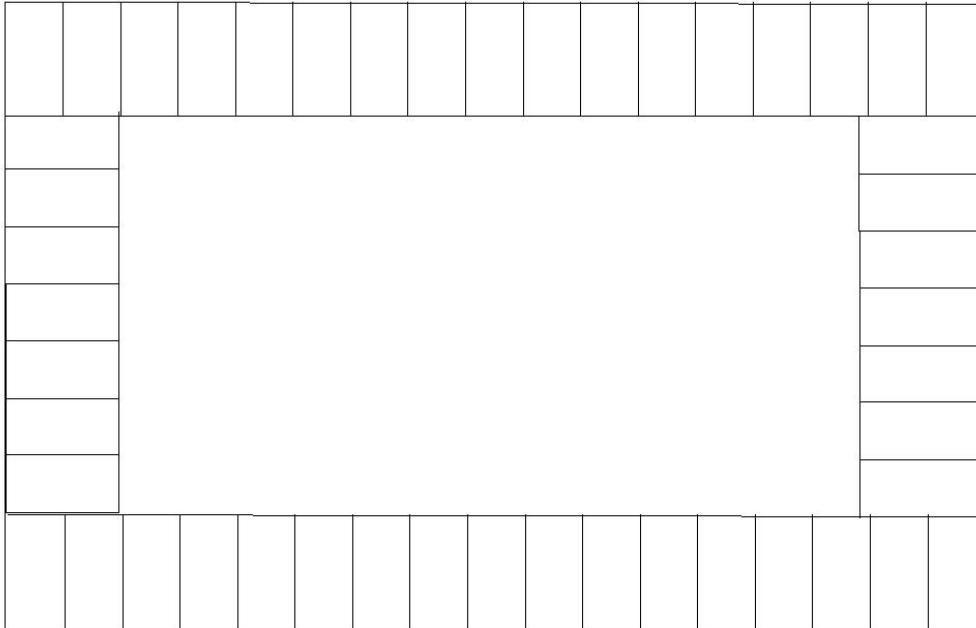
Planimetria della disposizione dei moduli fotovoltaici in copertura.
